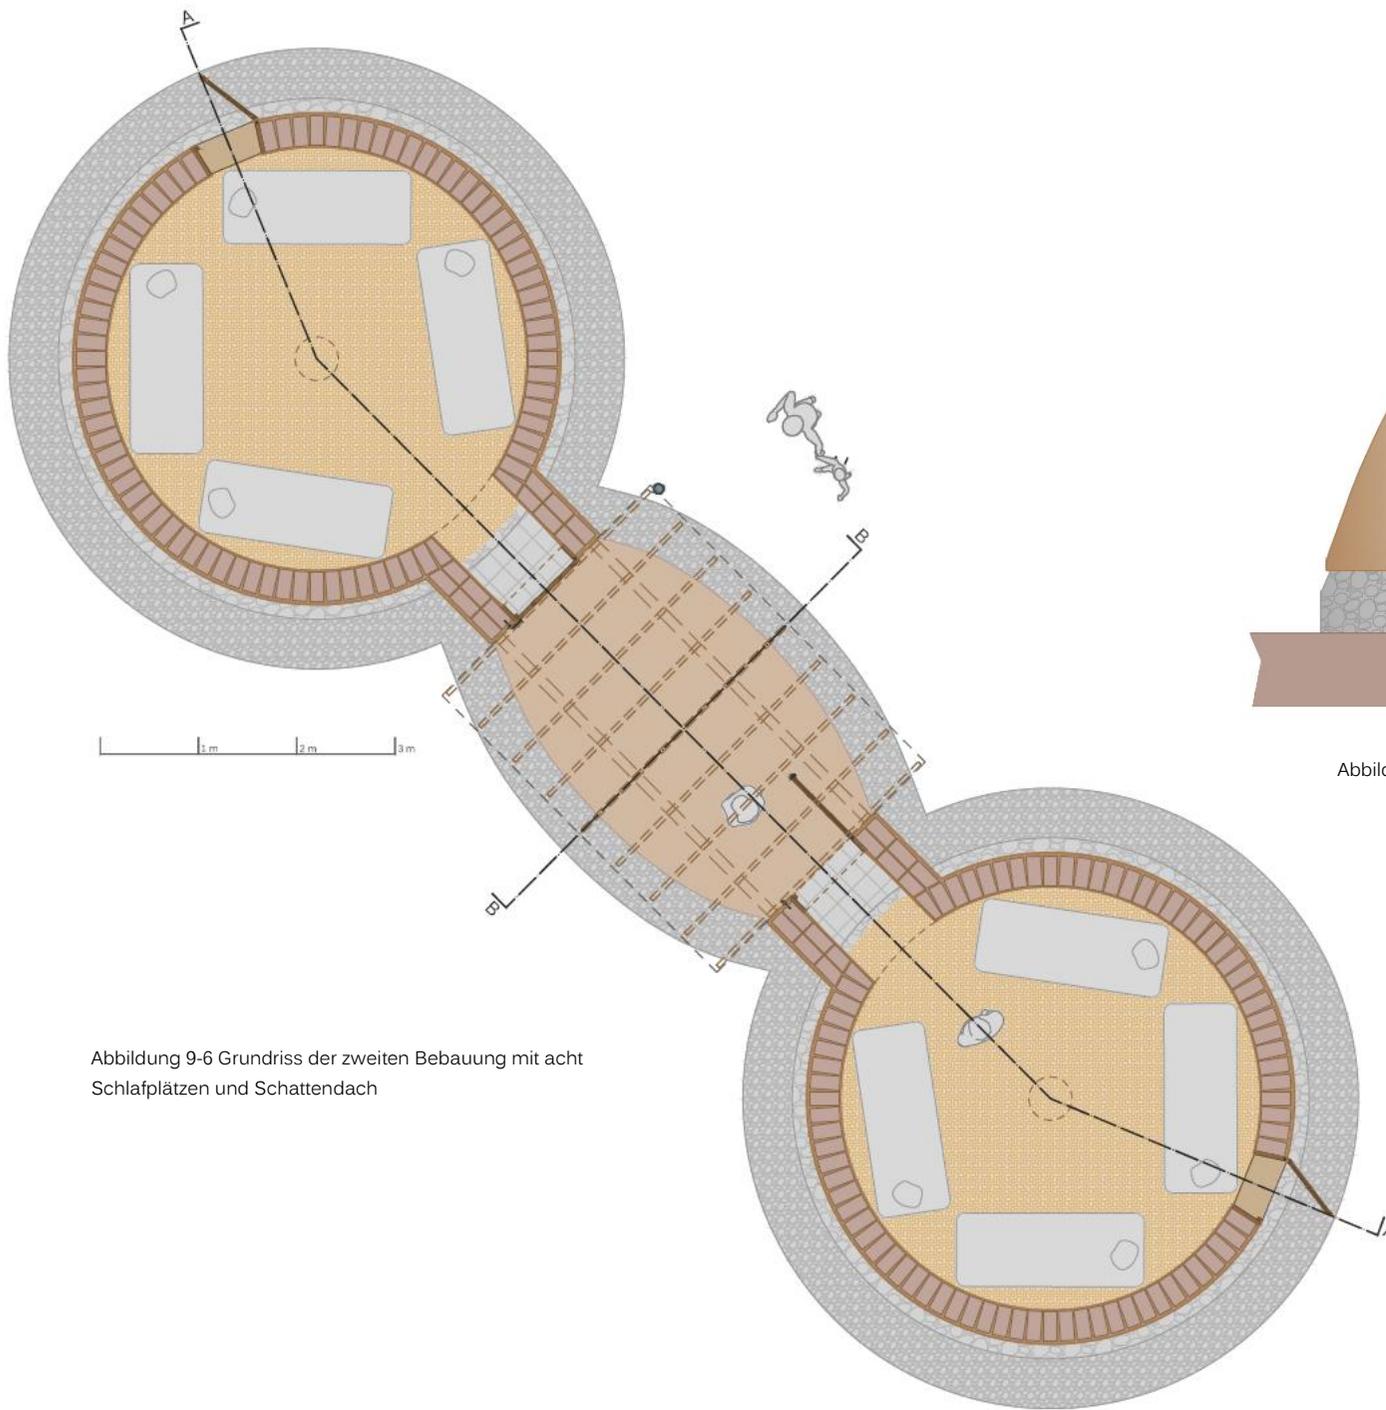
Grundriss der zweiten Bebauung mit acht Schlafplätzen und Schattendach
